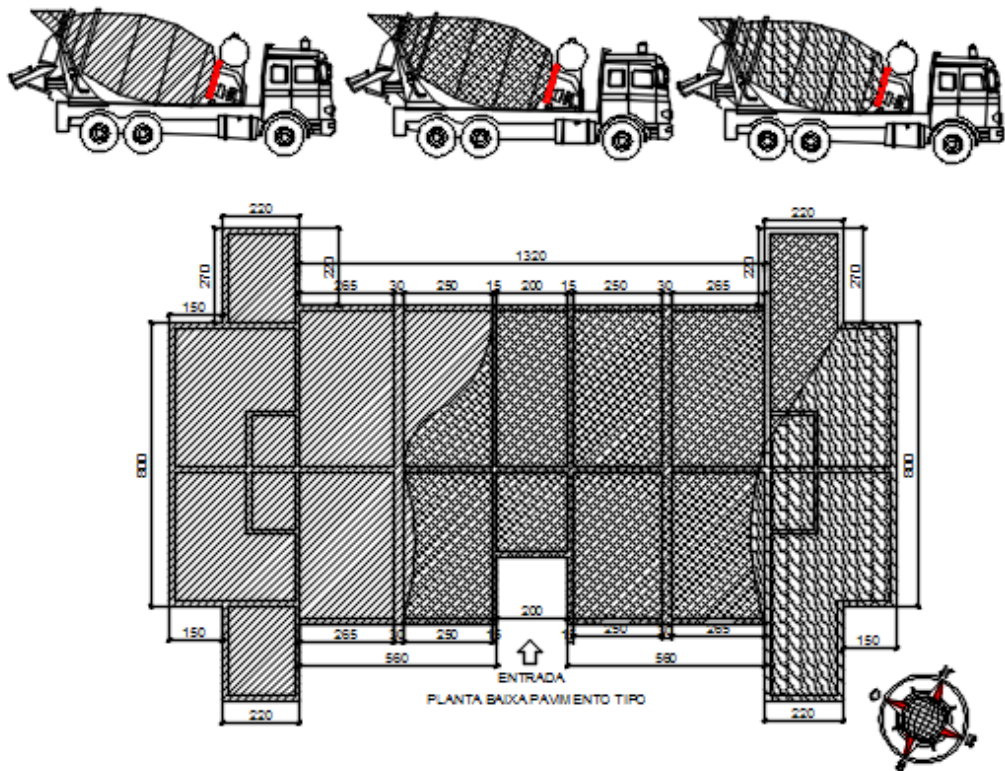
Exemplo da rastreabilidade do concreto aplicado na laje. Fonte: (do autor)
